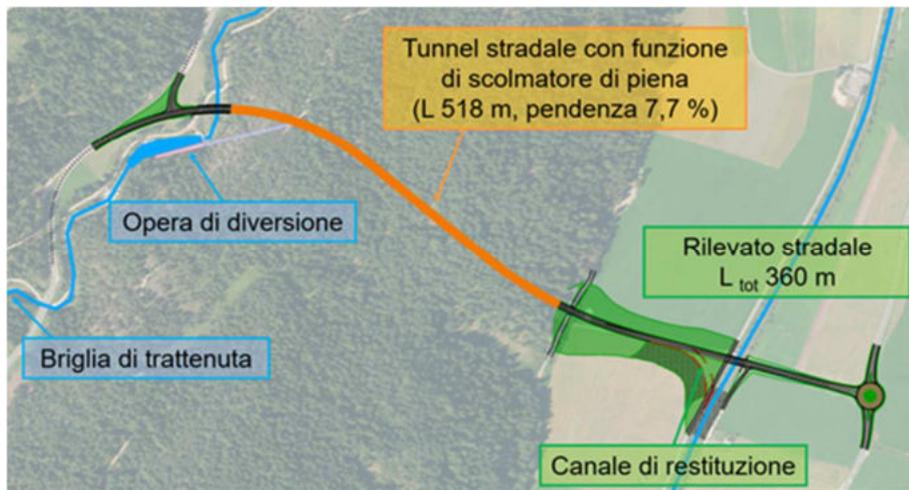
Localizzazione planimetria delle principali opere in progetto.
